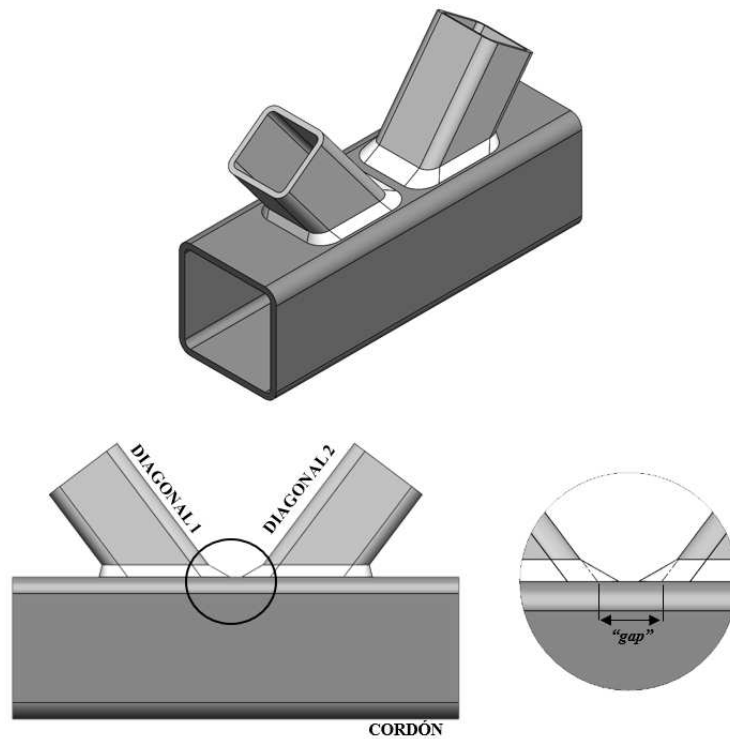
Tipología de conexión K con espaciamiento (gap).
